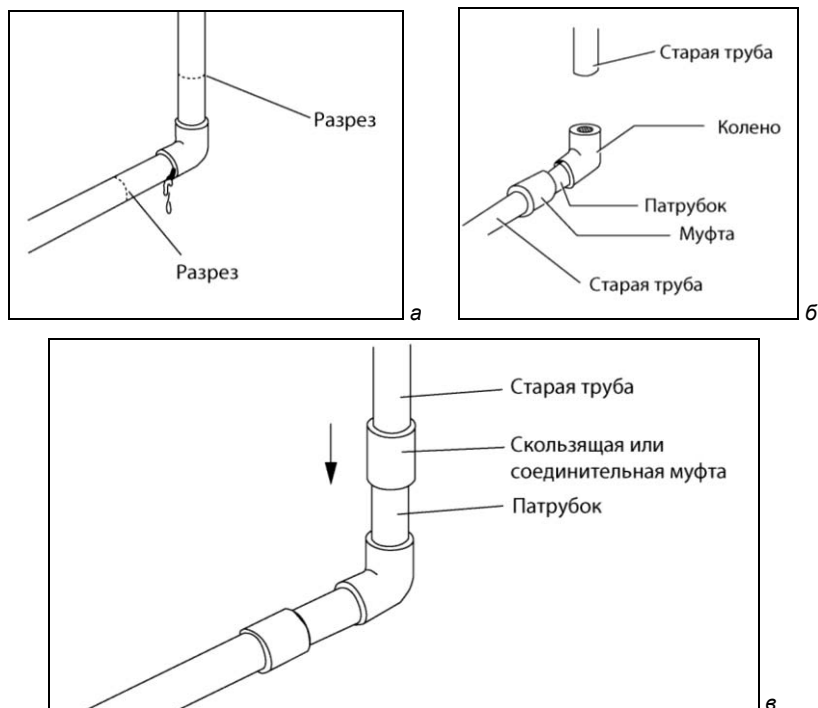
Ремонт протекающего фитинга медной или пластиковой трубы: вырежьте плохой фитинг (а); с одной стороны установите обычные фитинги (б); для завершения работы воспользуйтесь патрубком и соединительной или скользящей муфтой (в)
